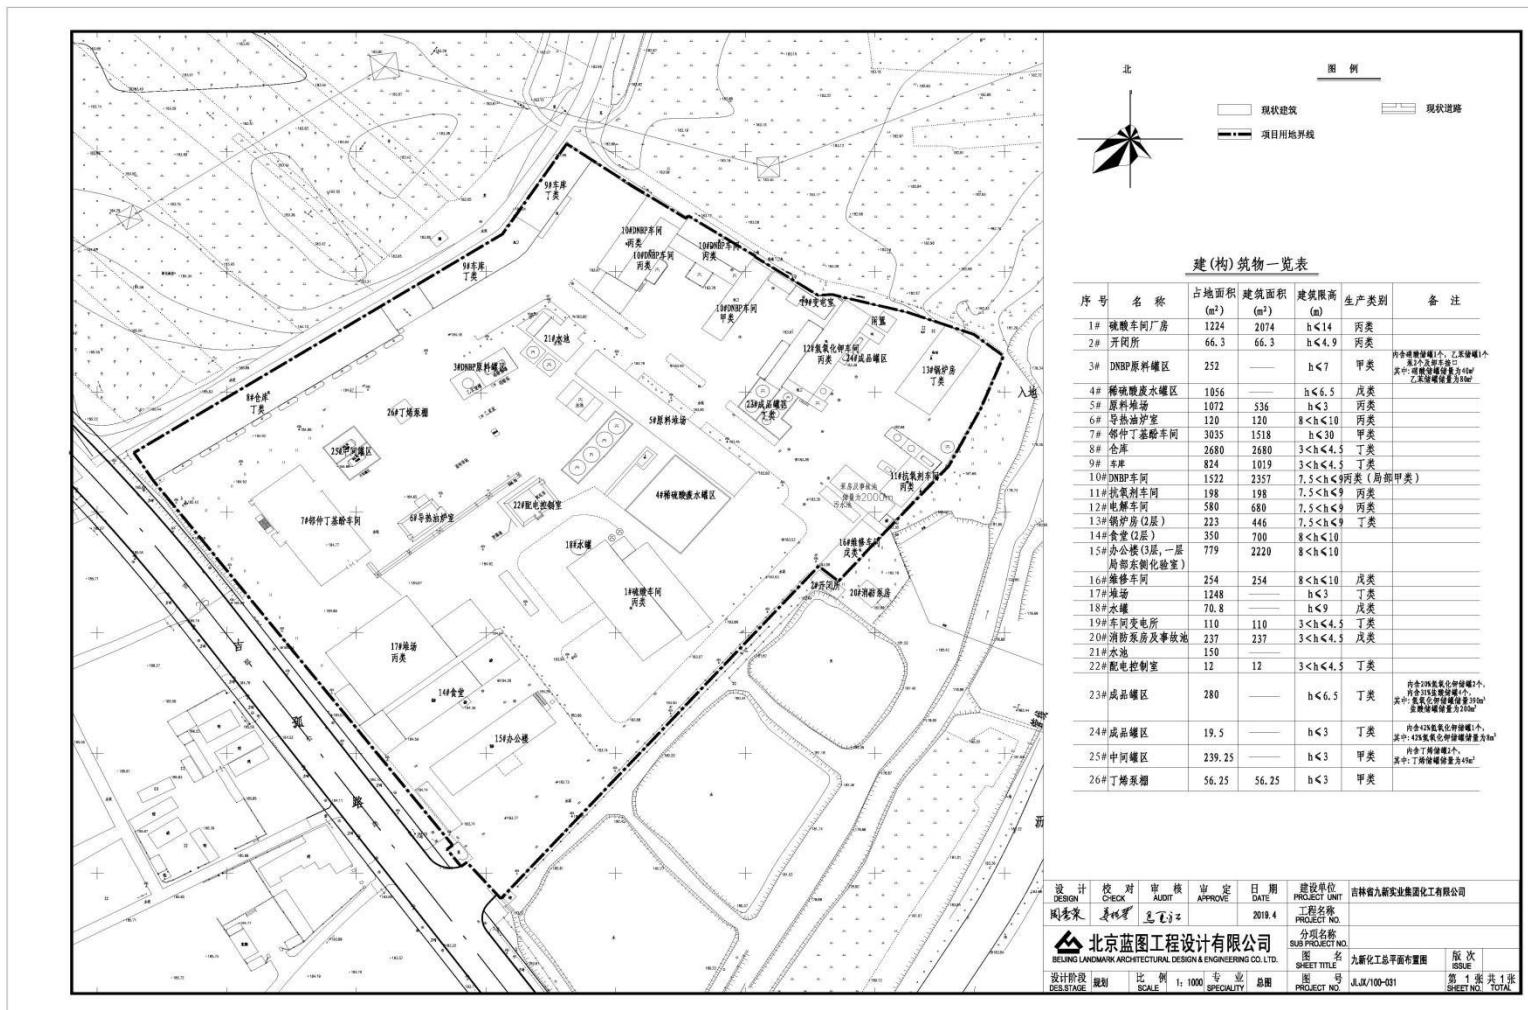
吉林省九新实业集团化工有限公司 平面布置图
